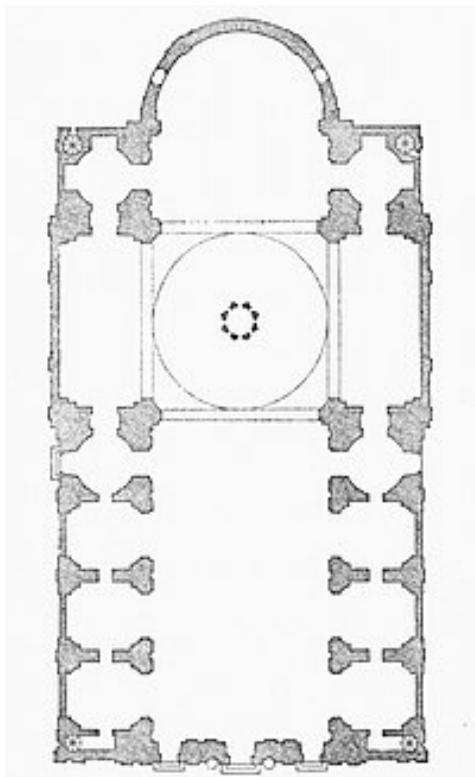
Planta do Gesù em Roma, Vignola (1568).
